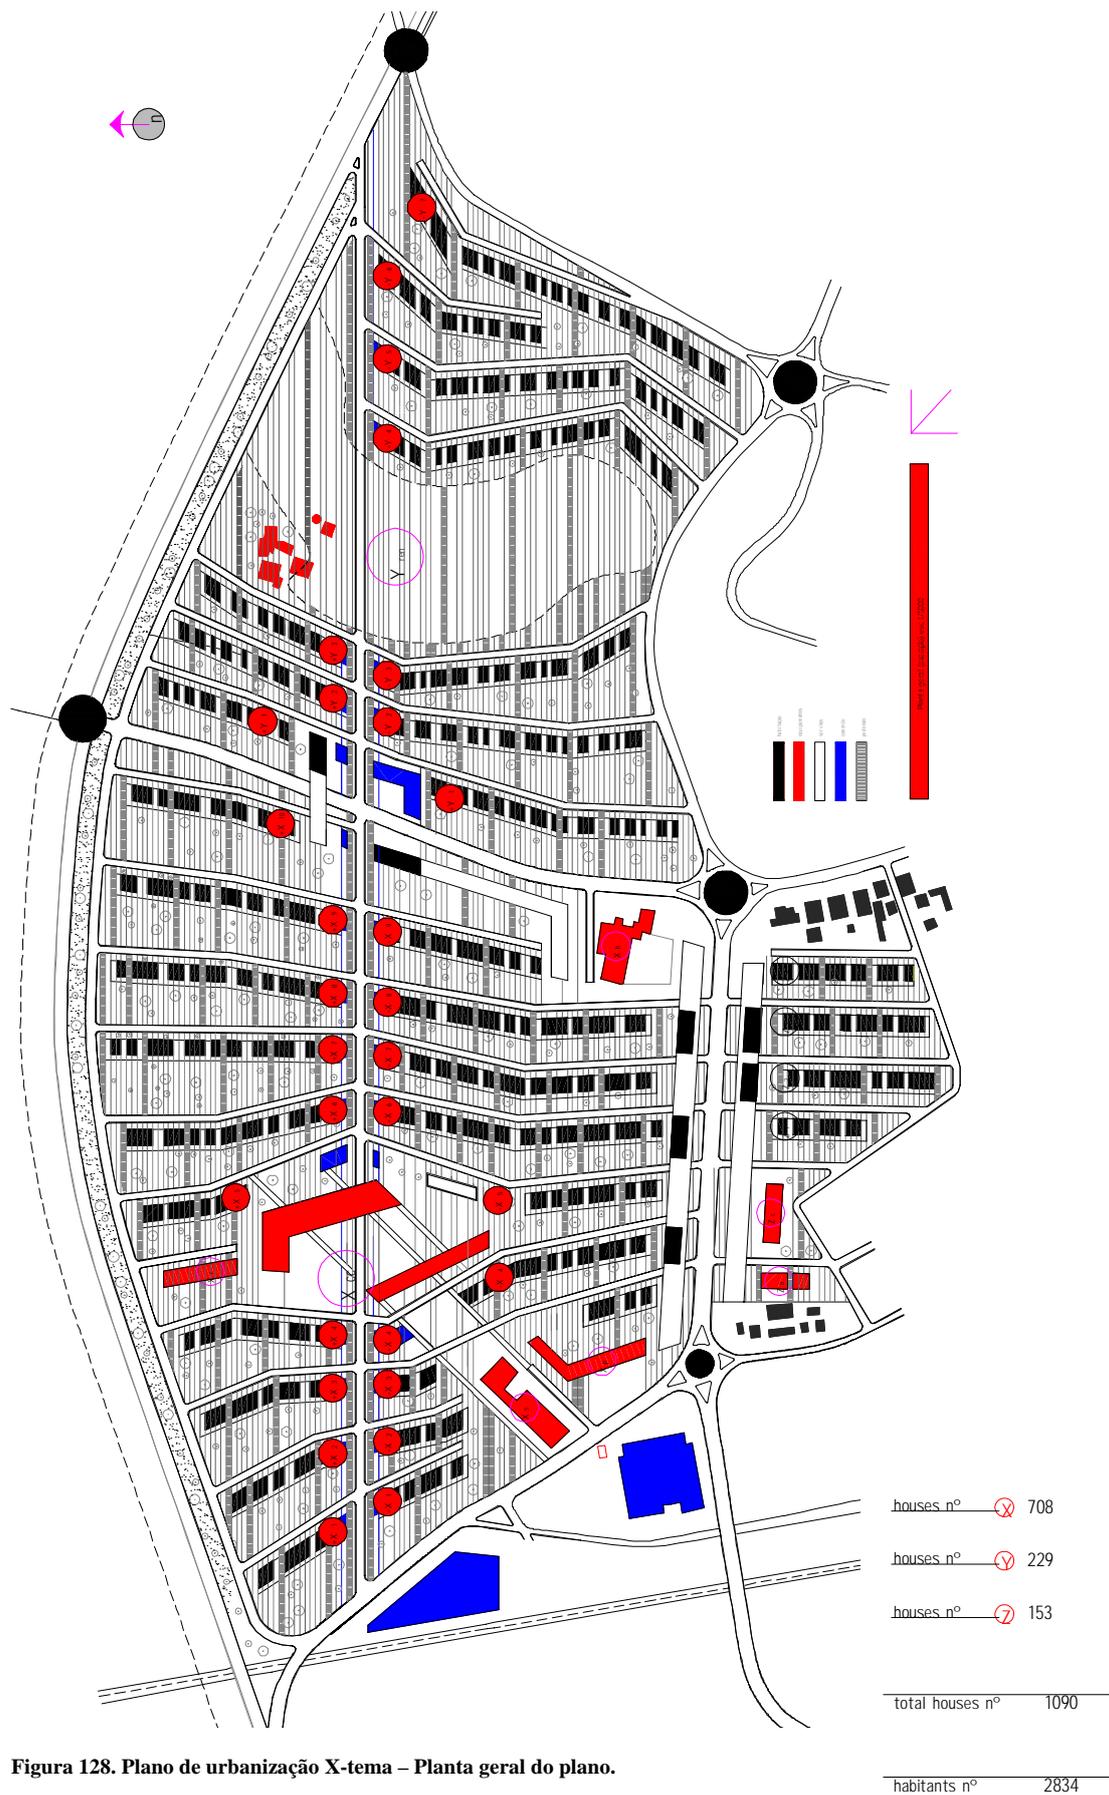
Plano de urbanização X-tema – Planta geral do plano.
